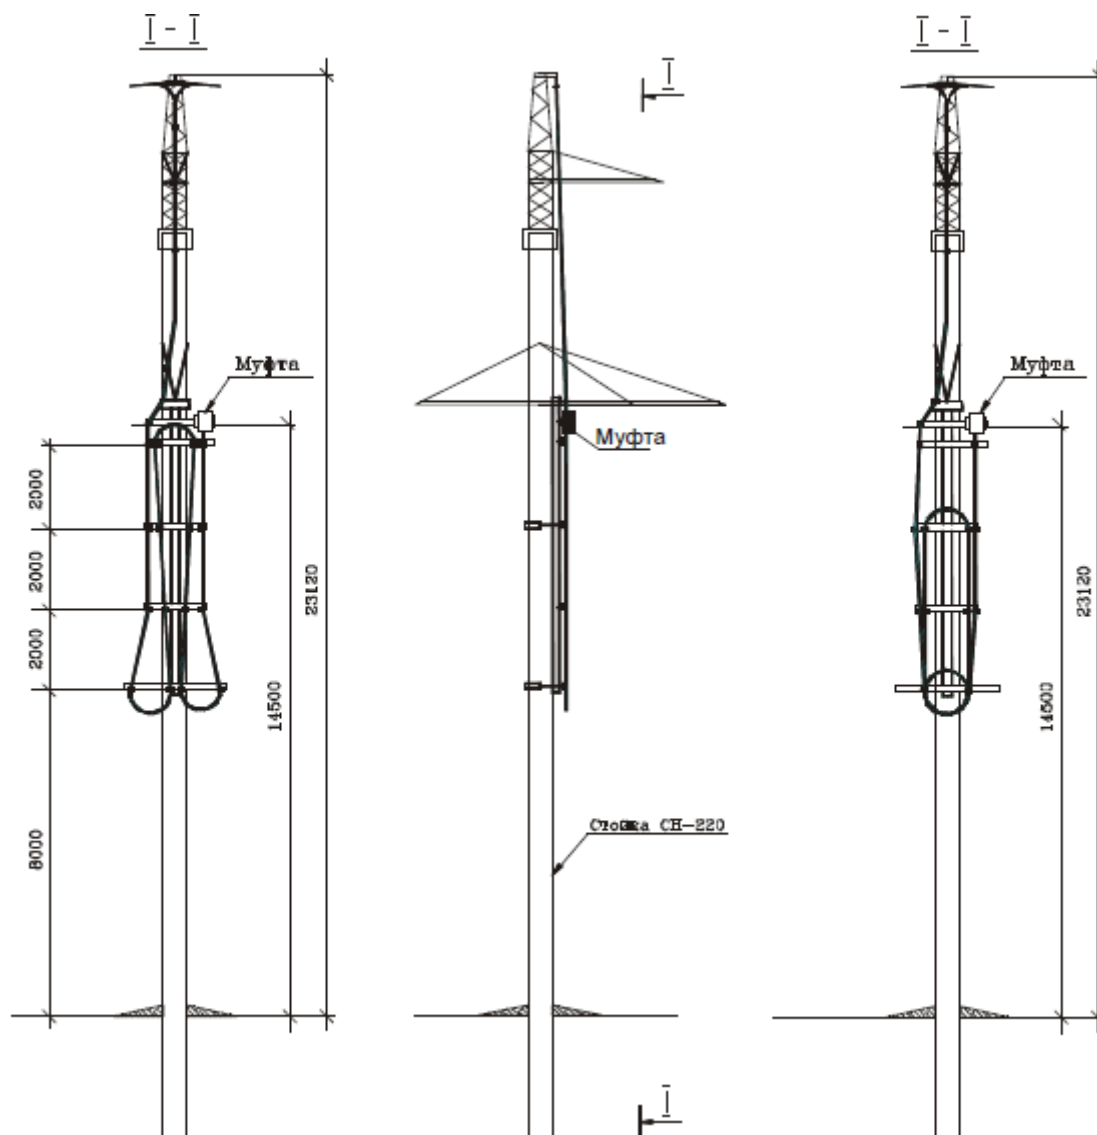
Размещение ОКГТ на железобетонной опоре (варианты)
